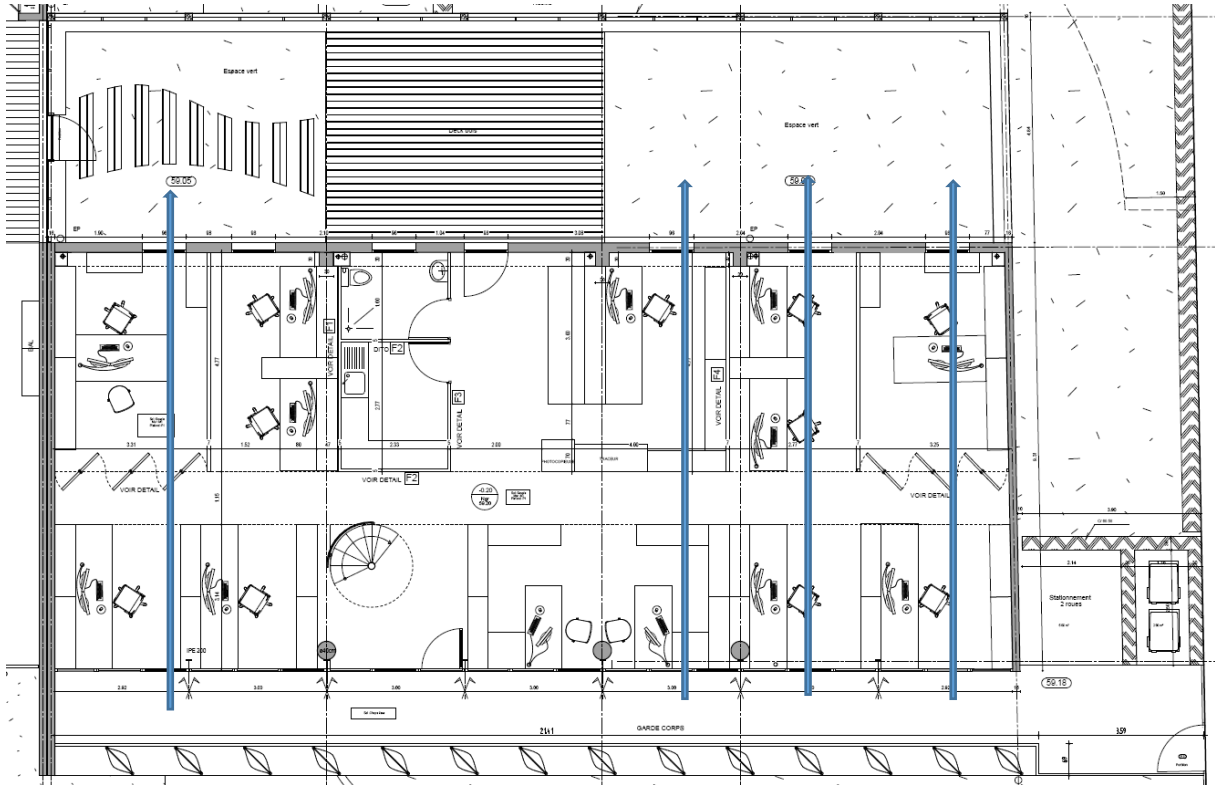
17: Plan traversant des bureaux – Ilet du Centre (© auteur)
